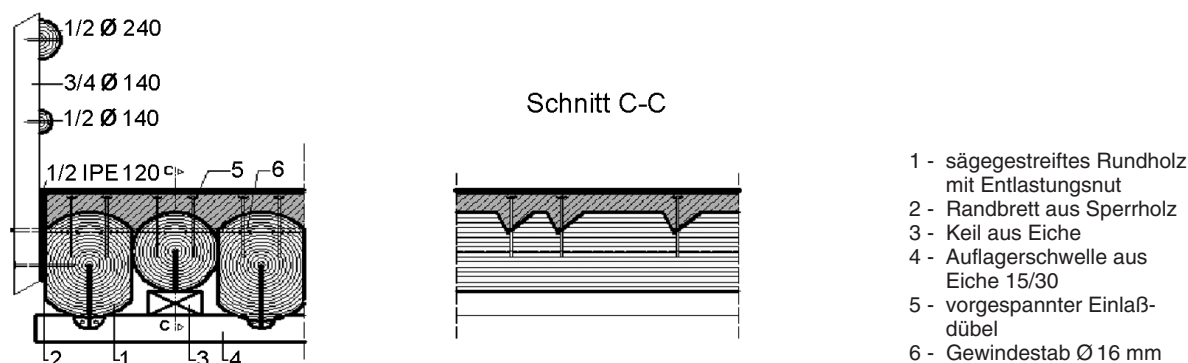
Rundholz-Verbundkonstruktion für eine Schwerlastbrücke (13 m Spannweite) nach Natterer in [1]
